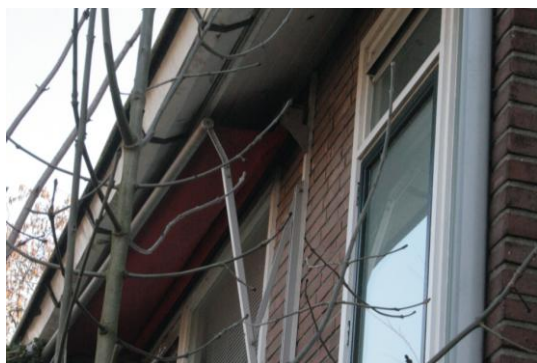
, boomlaan met links het noordelijke, te slopen bouwblok (zie ook figuur 3 blz.8)
